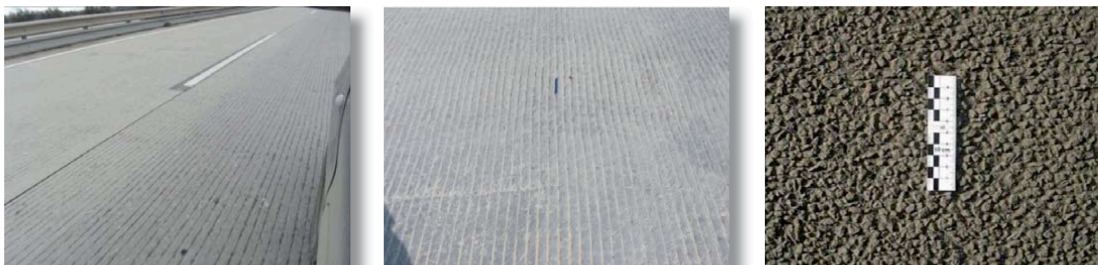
Texturas superficiales firmes de hormigón. Estriado longitudinal, estriado horizontal y árido visto.
